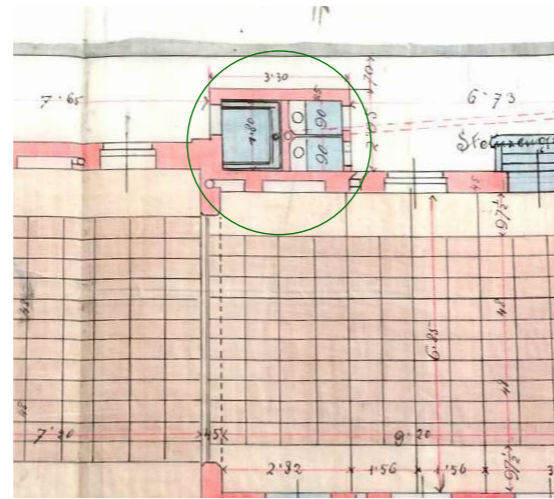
Grundriss Auswechslung (1884) [ma37]
